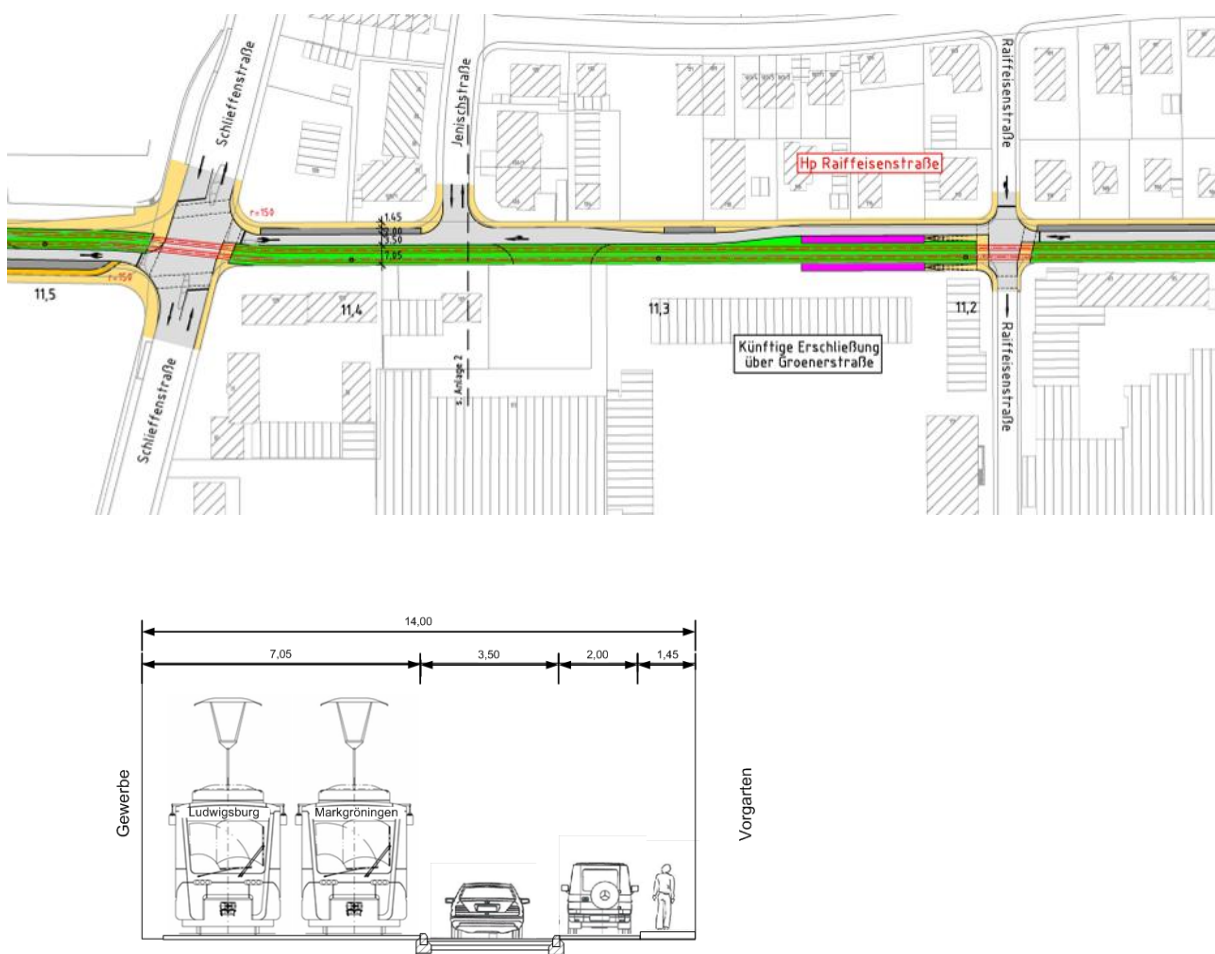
Lageplan und Querprofil Mörikestraße Teil Ost, Blickrichtung Westen (Planung)
